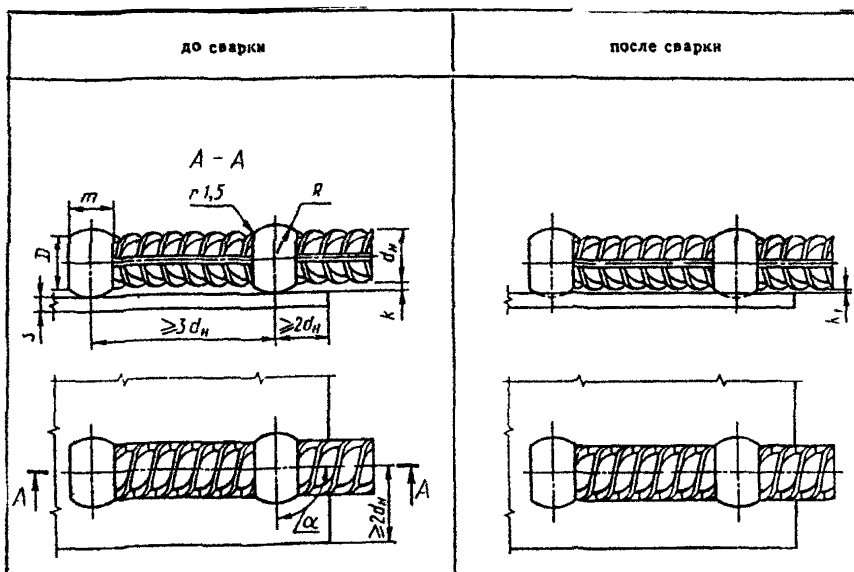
Конструкция нахлесточного соединения, выполняемого контактной рельефной сваркой по двум рельефам на арматуре
